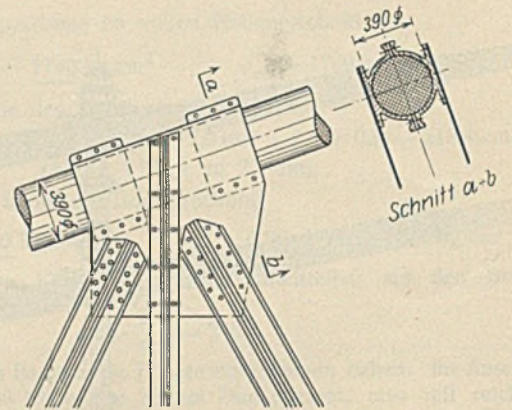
Anschlußpunkt des Fachwerkes an das Kabel bei dem Entwurf nach Abb. 24.
